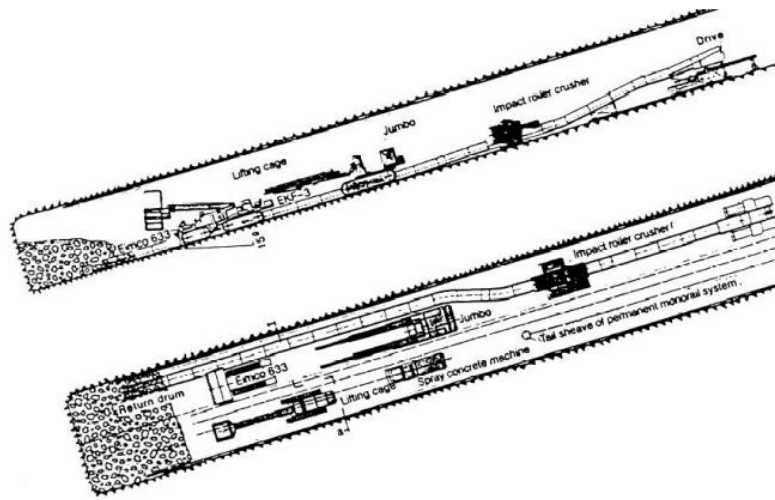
Excavación de plano inclinado mediante PyT [3]
